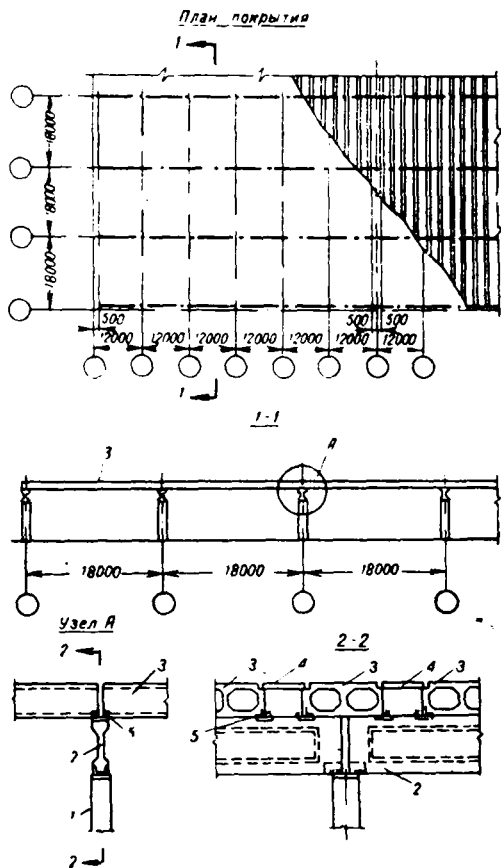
Покрытие здания из длинномерных пустотных настилов
